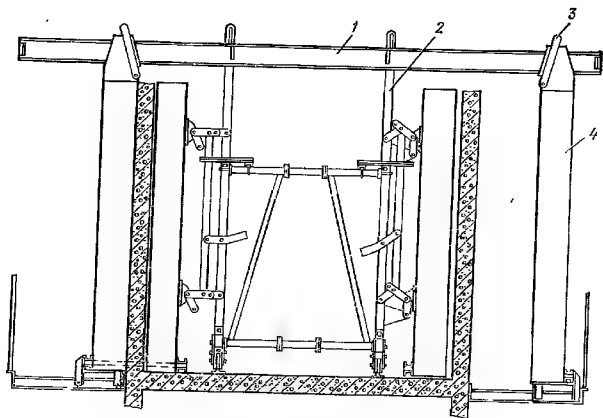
Опалубка с консольно подвешенными наружными боковыми щитами:
